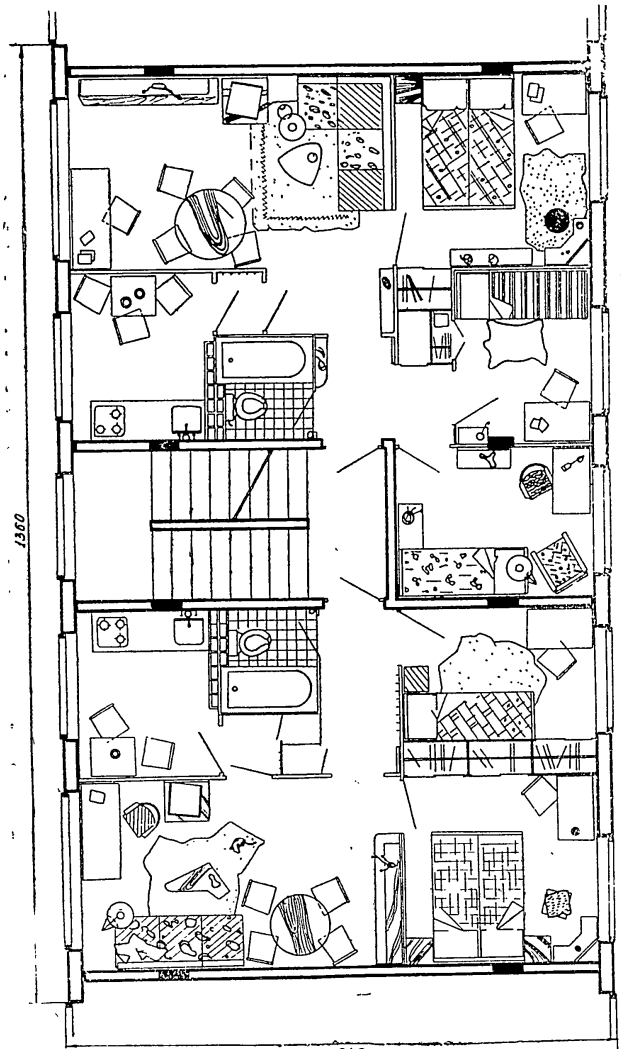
План рядовой секции жилого дома с поперечными несущими конструкциями.
